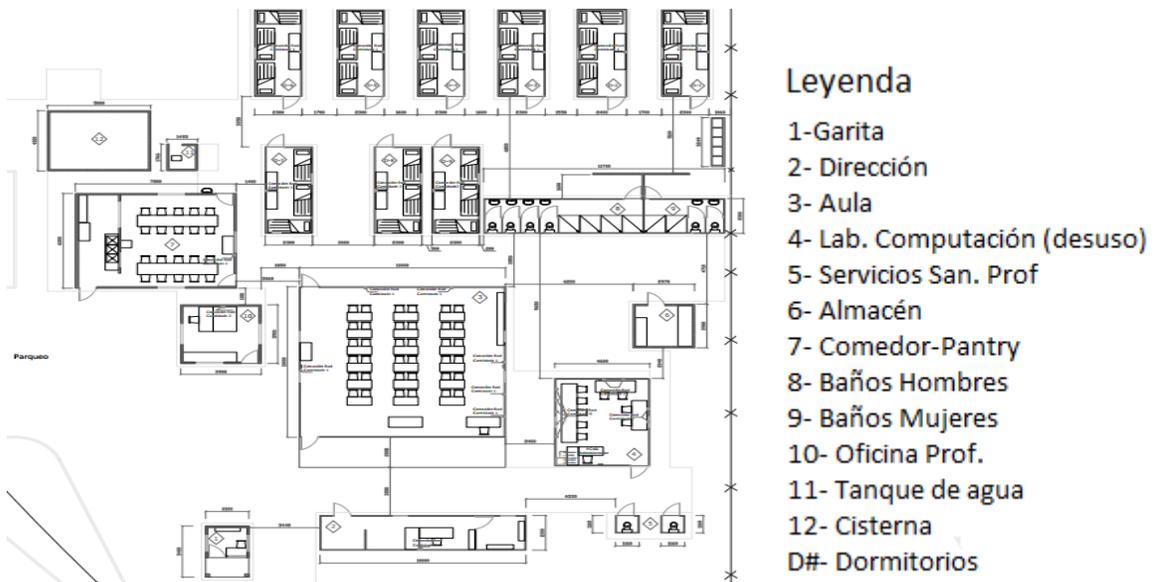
Planta general de la sede universitaria Cayo Santa María. Fuente: Facultad de Construcciones. UCLV
